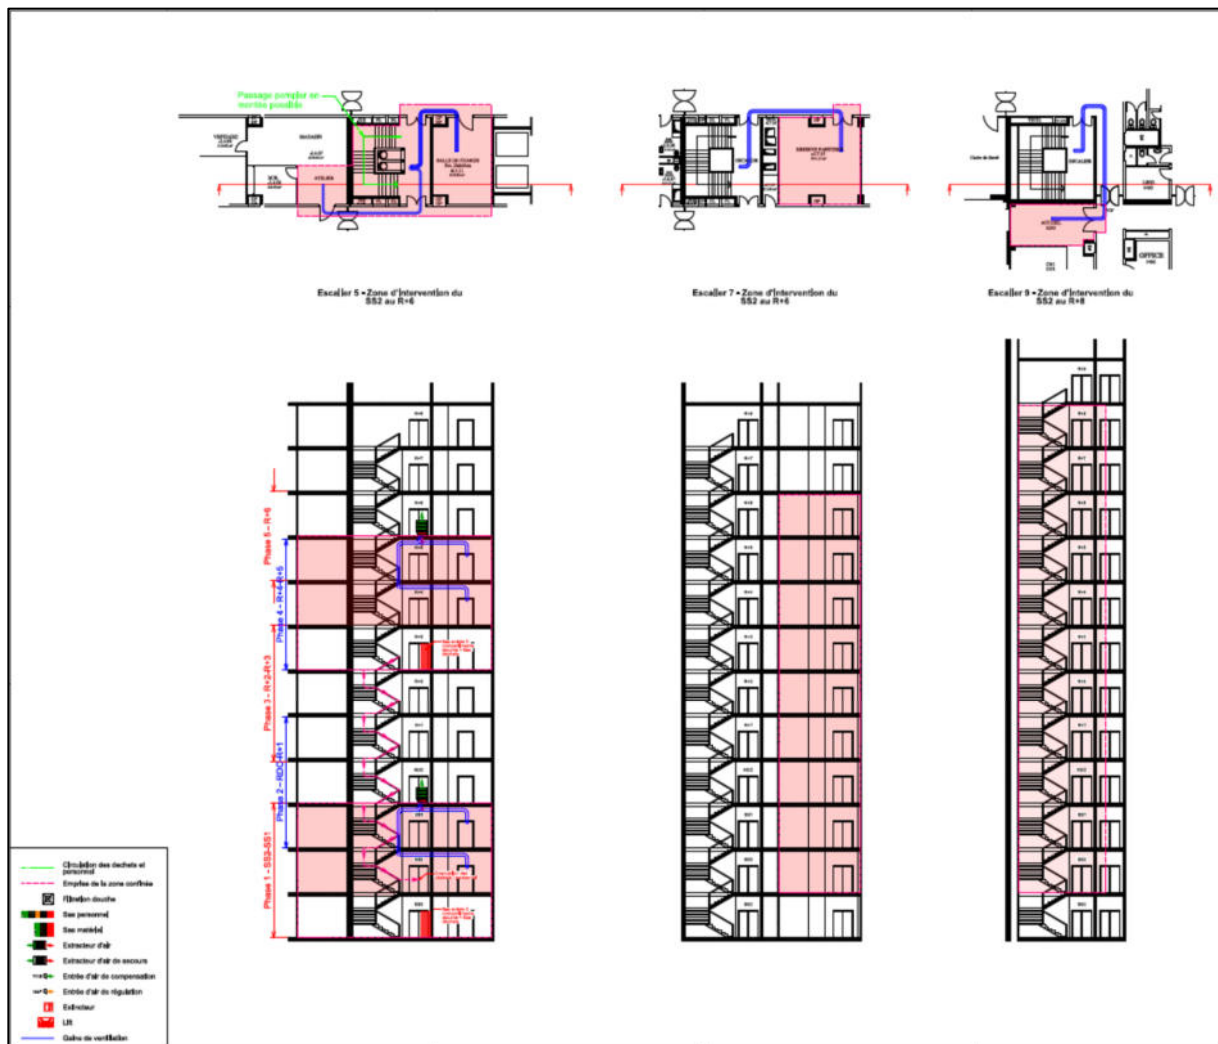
Traitement des zones escaliers – Travaux préalables – Extrait carnet de plans TSF DCE 0504 ANT PL AMI TTN A
